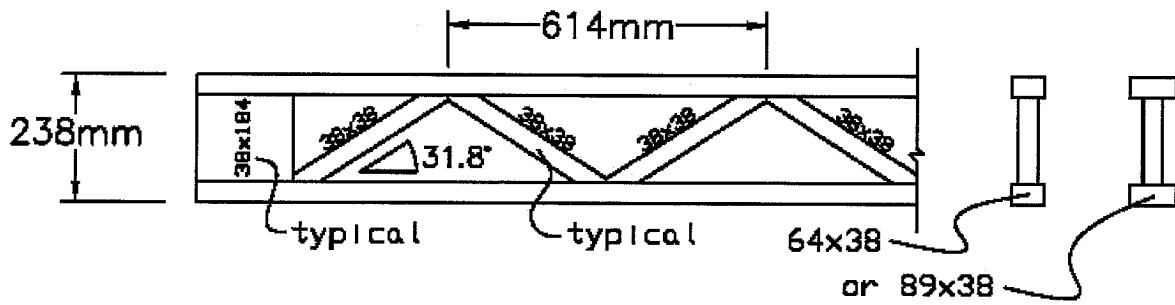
OPEN JOIST 2000 – HAUTEUR 238 mm
